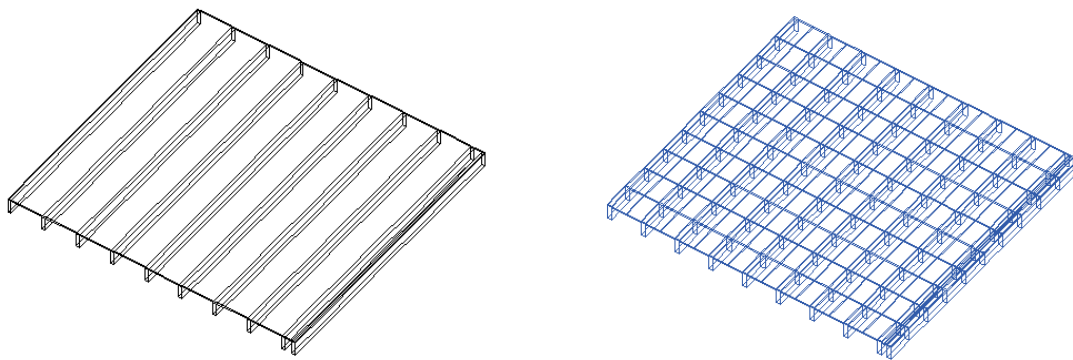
Beispiel einer Holzbalkendecke aus Balkenlage und Beplankung mit Diskretisierung in Hexaederelementen
